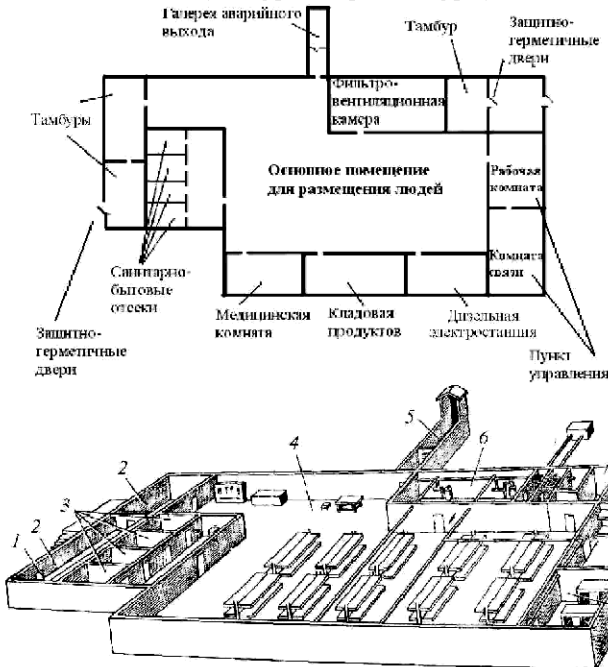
План убежища: 1 - защитно-герметические двери; 2 - шлюзовые камеры (тамбуры); 3 - санитарно-бытовые отсеки; 4 - основное помещение для размещения людей; 5 - галерея и оголовок аварийного выхода; 6 - фильтровентиляционная камера; 7 - кладовая для продуктов питания; 8 - медицинская комната
